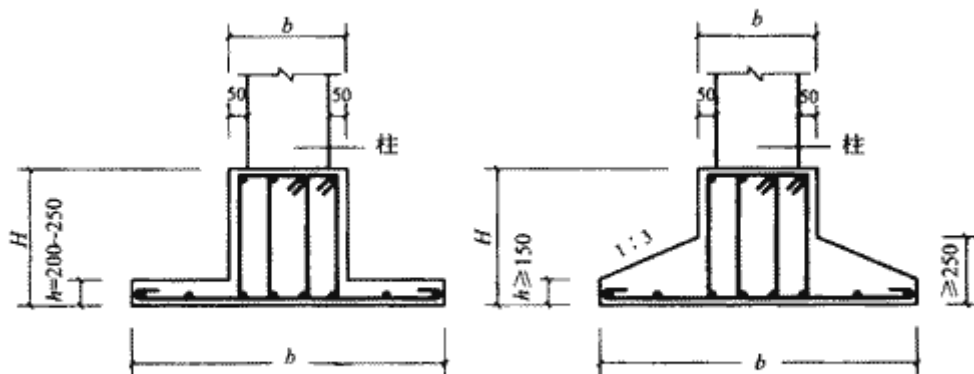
柱下钢筋混凝土条形基础配筋构造示意图
